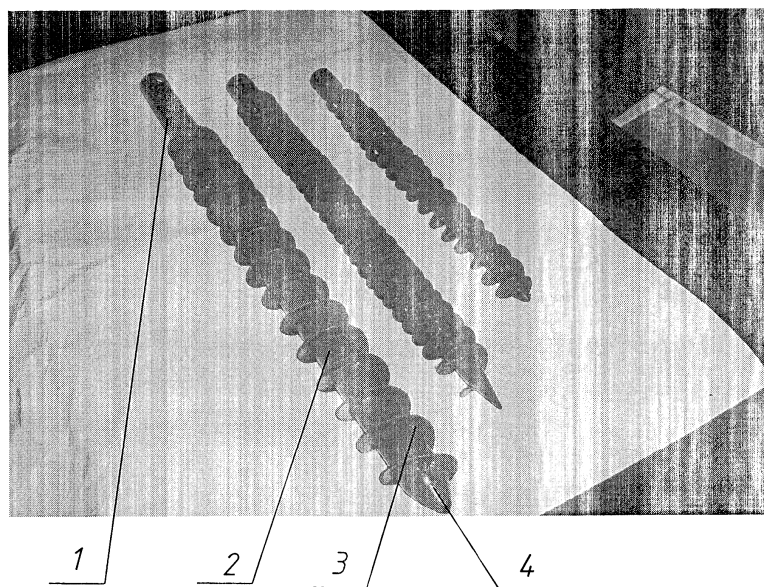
Експериментальні зразки гвинтових опор з різними конструктивними параметрами: 1 – корпус опори; 2 – циліндричний стержень; 3 – гвинтова спіраль шнека; 4 – конічна насадка
